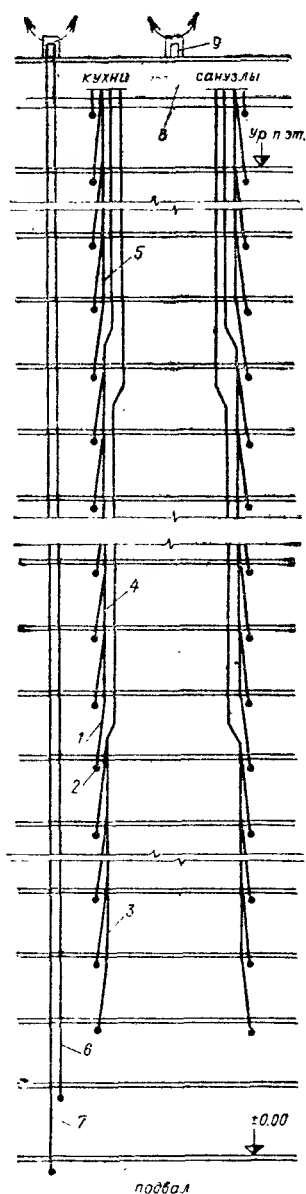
Схема устройства вытяжной вентиляции в многоэтажном здании
